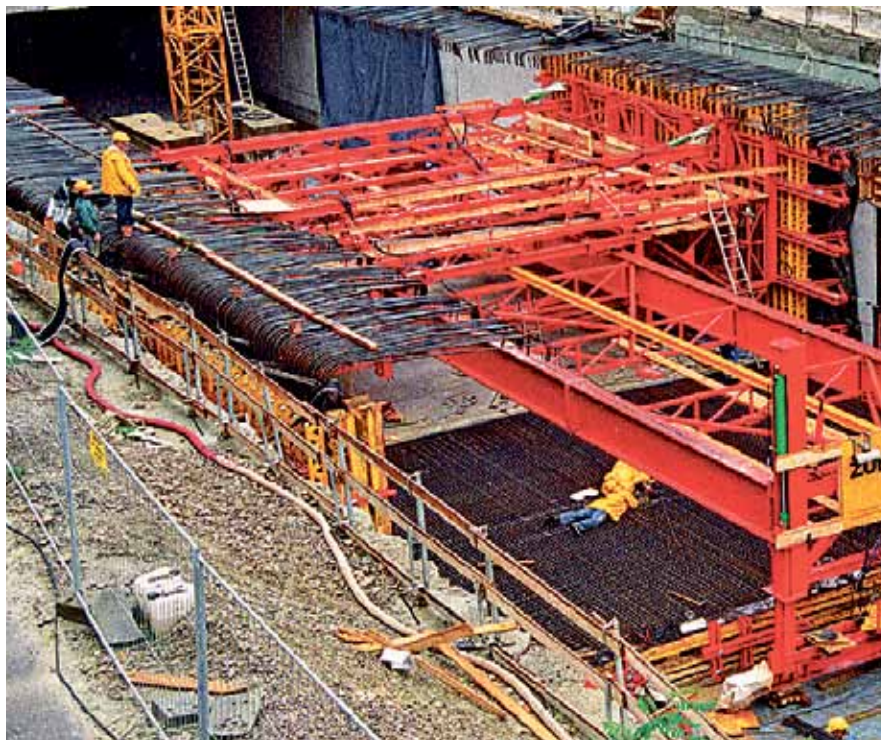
Wózek przejezdny na budowie tunelu U-Bahn w Hamburgu.
